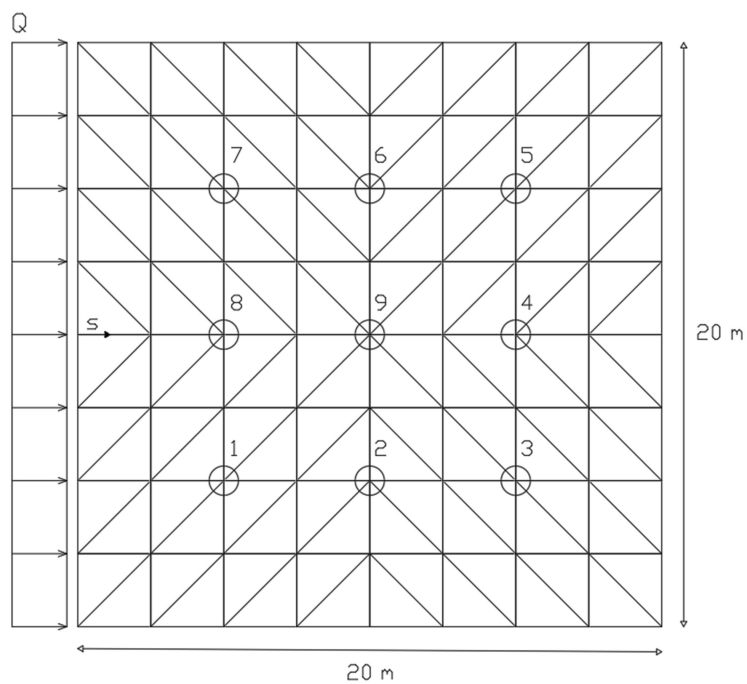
Radier estaqueado submetido a carregamento uniformemente distribuído.
